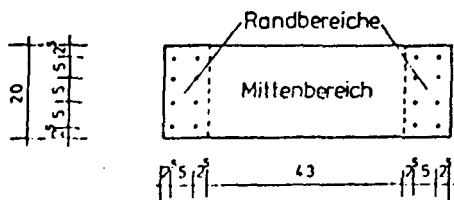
Bewehrungs- und Schalplan des Versuchskörpers ZK 10/1,5
